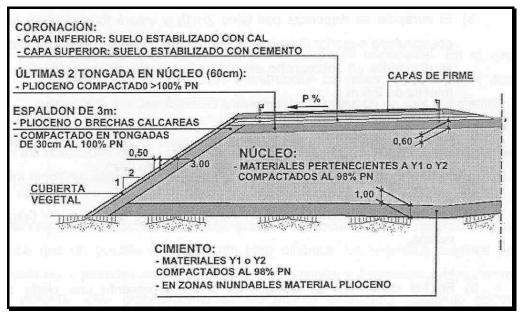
Sección tipo de terraplén ejecutado con arcillas yesíferas (Y<35%) en la R-4
